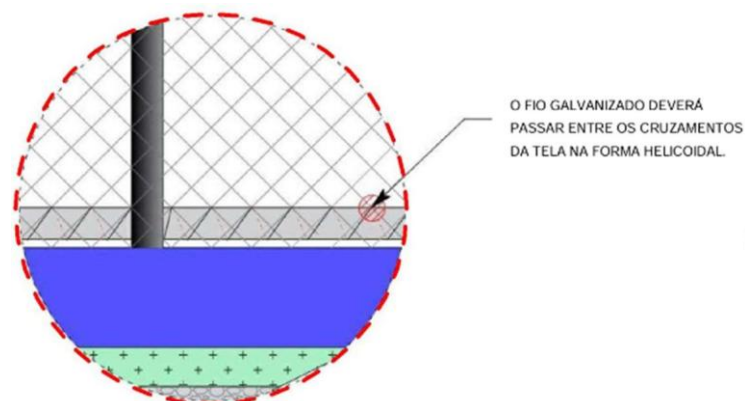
Detalhe da fixação das telas (Fonte: Autor/2025)
